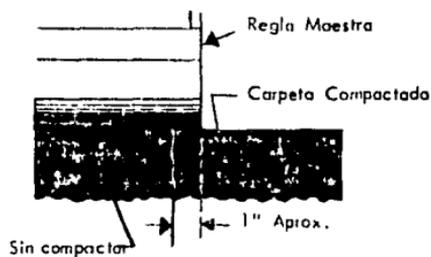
La pavimentadora traslapará el material con la capa contigua una o dos pulgadas (2.5 ó 5.1 cm).
